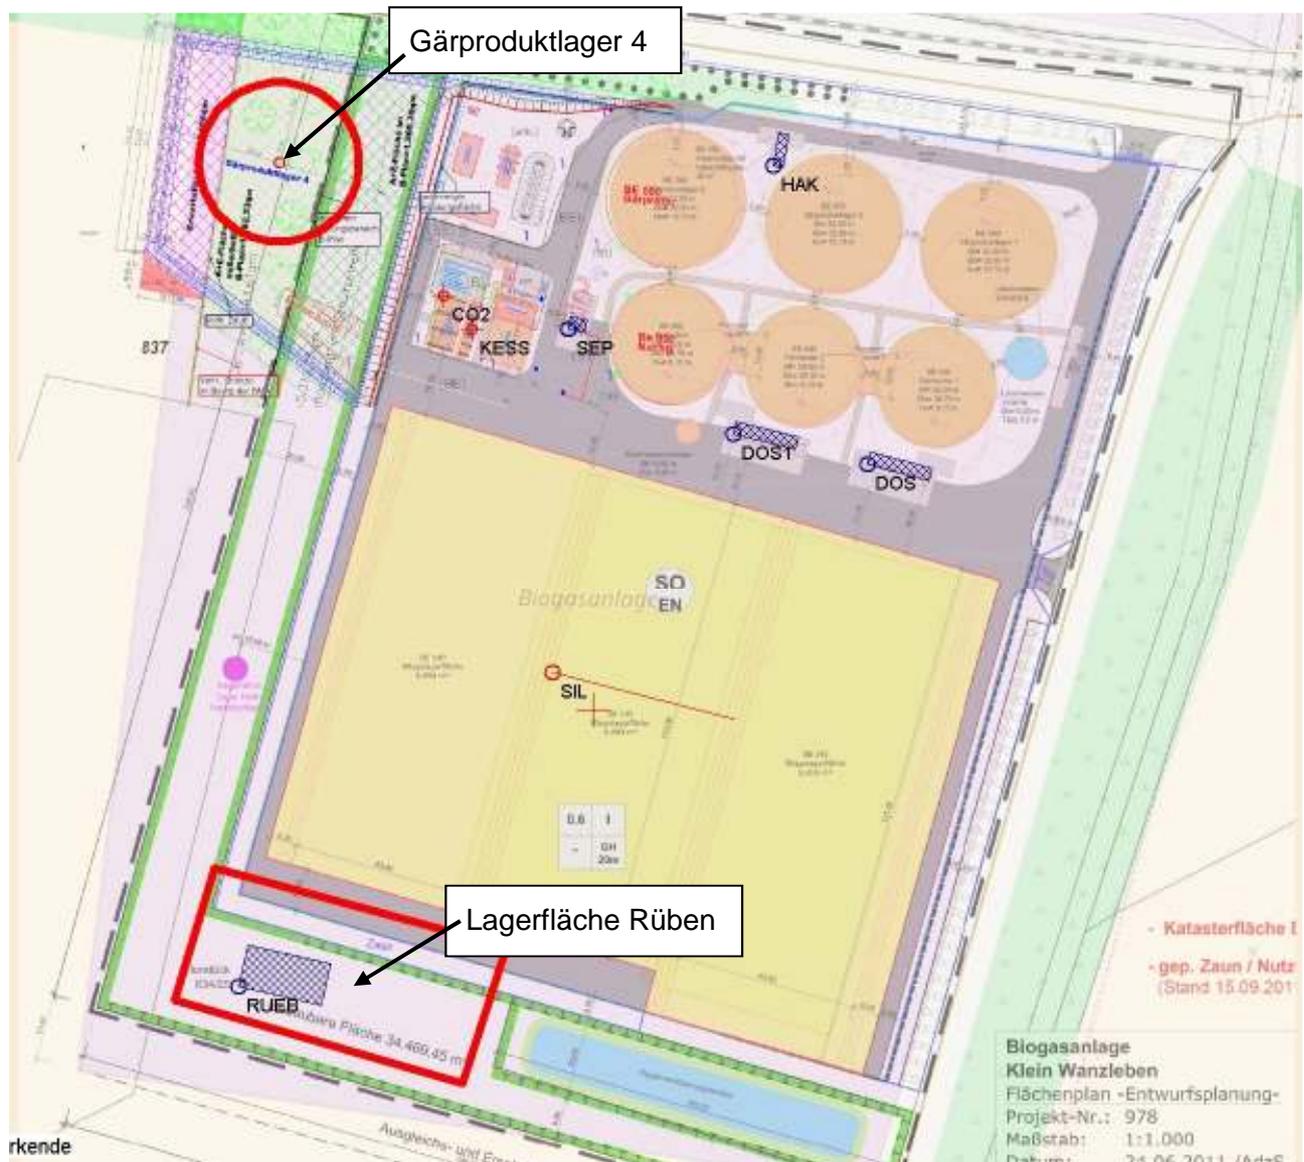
Lageplan der Anlage, Planungsstand April 2018
